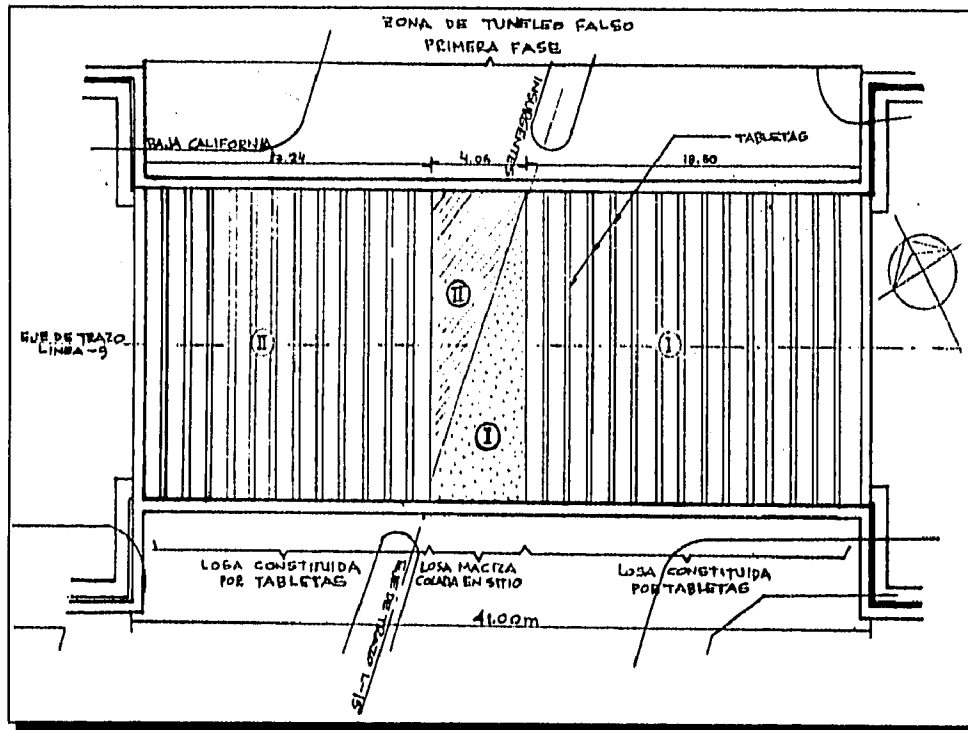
Planta de losa de la primera fase del tunelero.
